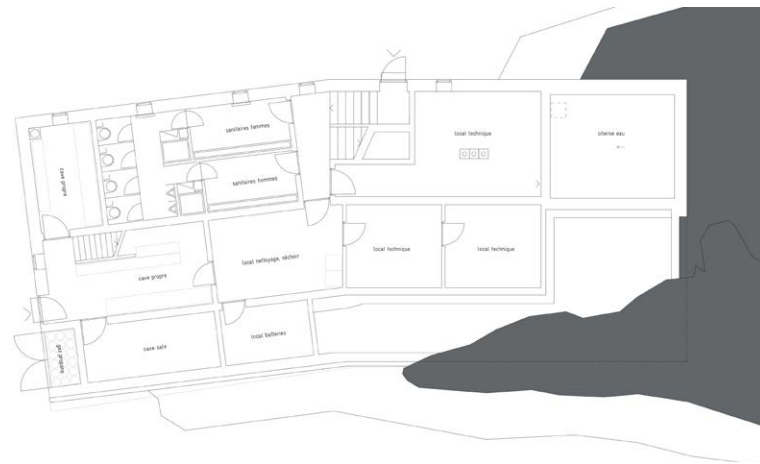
Pianta piano primo seminterrati del Tracuit Hütte
